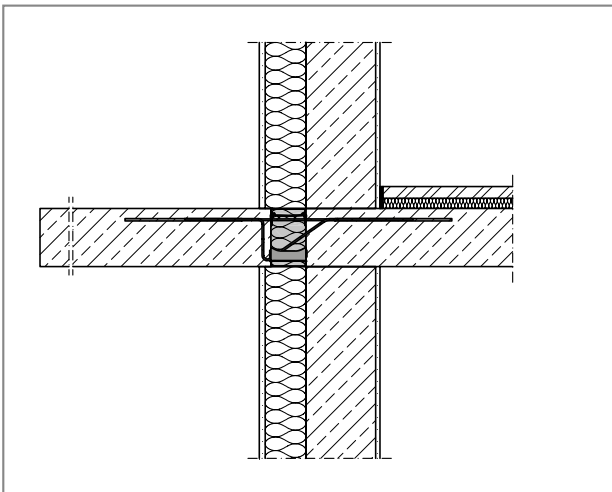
Darstellung einer Schnittzeichnung mit detailliertem Schöck Isokorb® Modell
